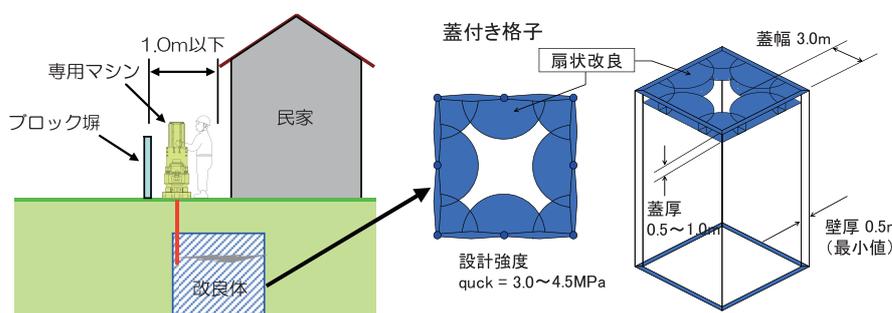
超小型施工マシンを用いた施工概略図（蓋付き格子改良）
